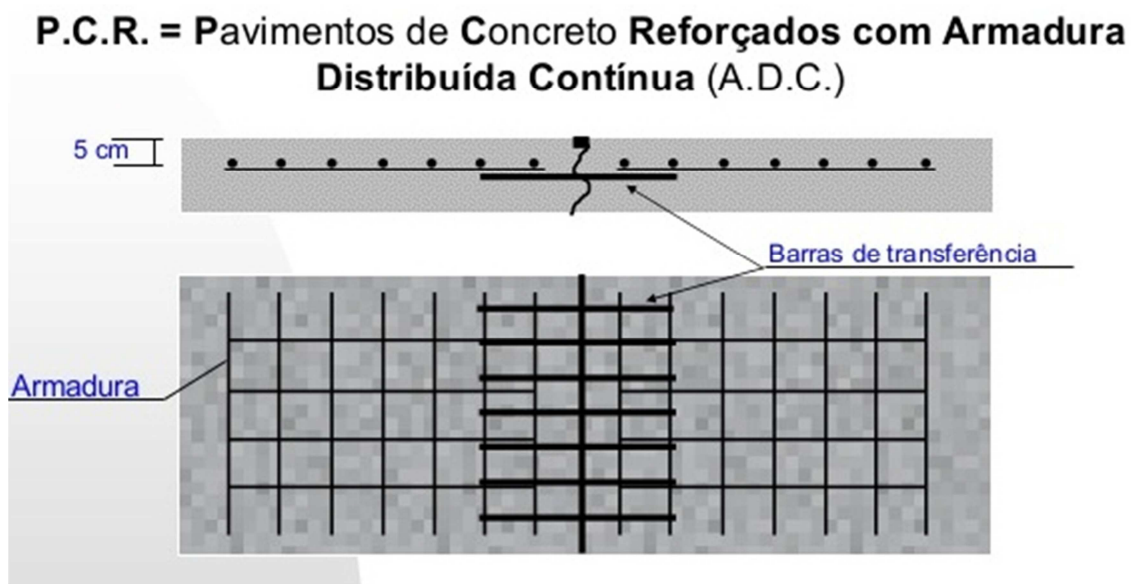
Pavimentos de Concreto Reforçado com Armadura Distribuída Contínua.
